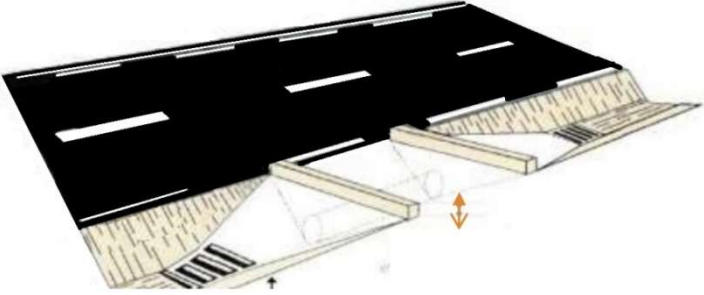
Situation des réseaux d'assainissement sur le profil en travers d'une route.
